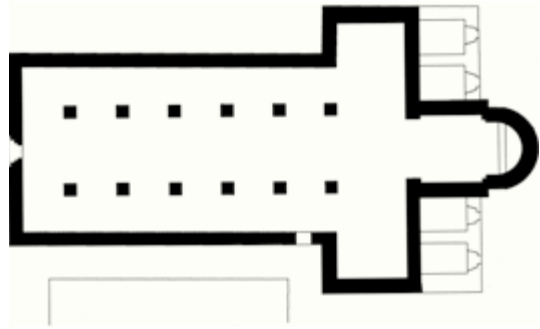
Grundriss der ehem. Stiftskirche Wilhering mit Hervorhebung der Bauteile des 12./13. Jahrhunderts
